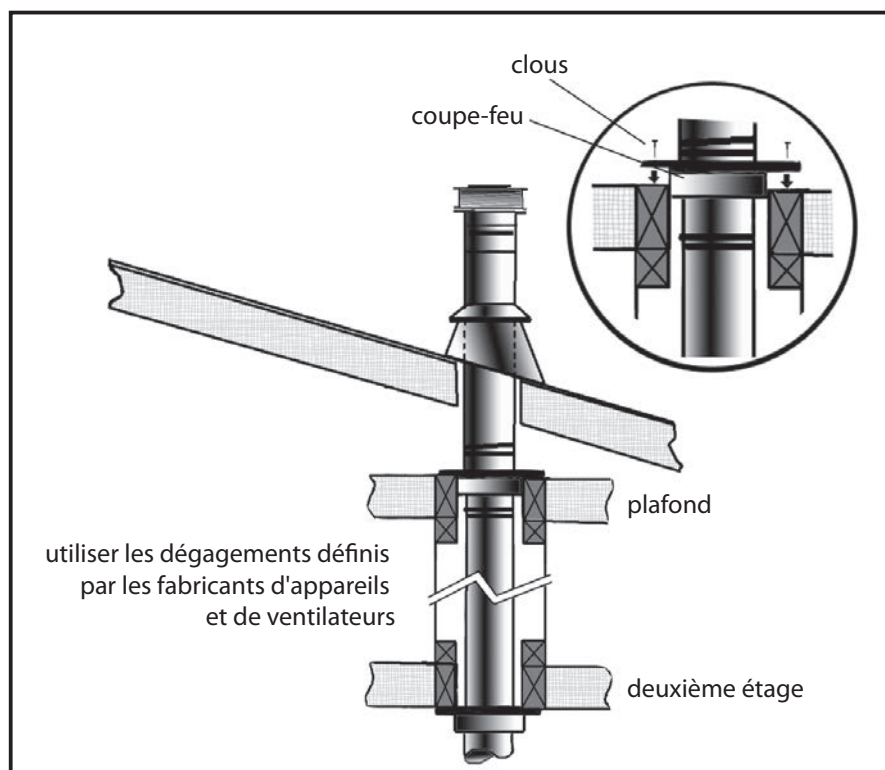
installation de tuyaux de ventilation sur plusieurs étages
